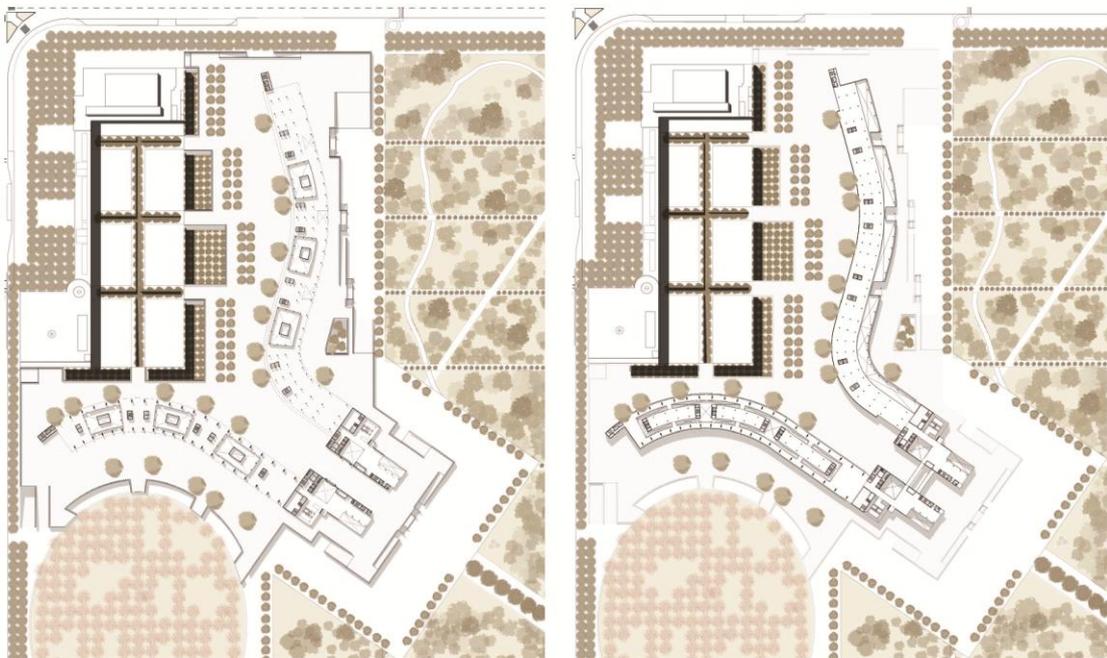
Planta de acceso y planta principal. Ilustración del autor.
